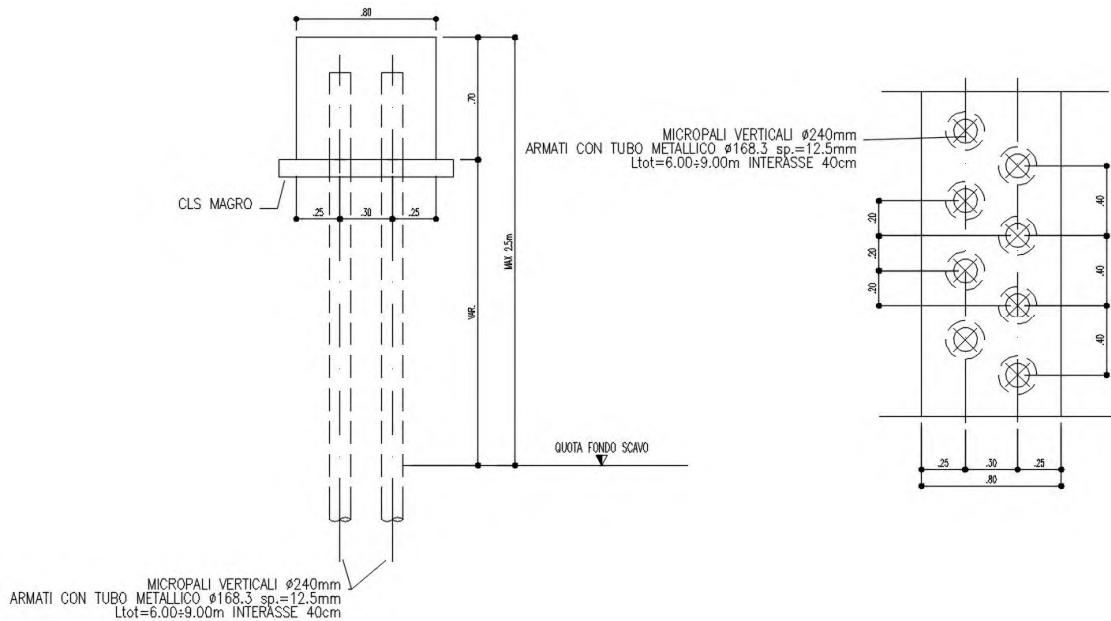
Sezione tipo B (Cavalcavia Ferroviario)
